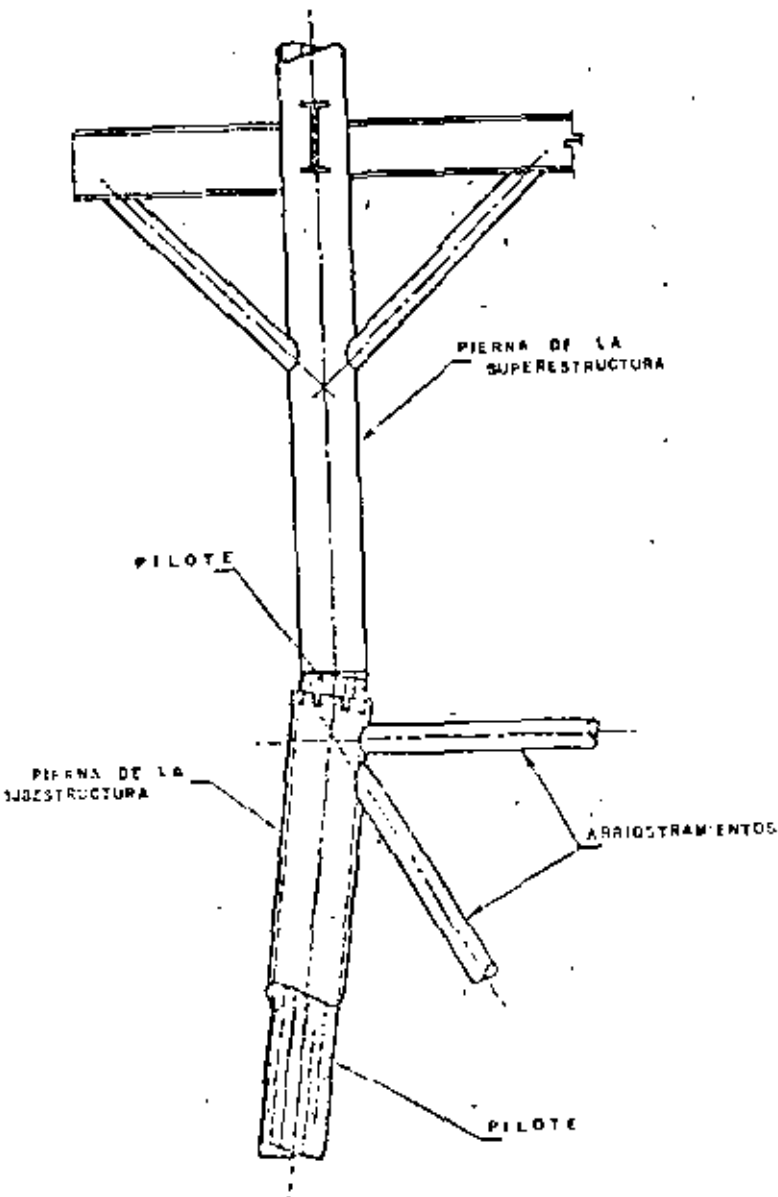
CONEXION SUBESTRUCTURA - SUPERESTRUCTURA - PILOTE.
